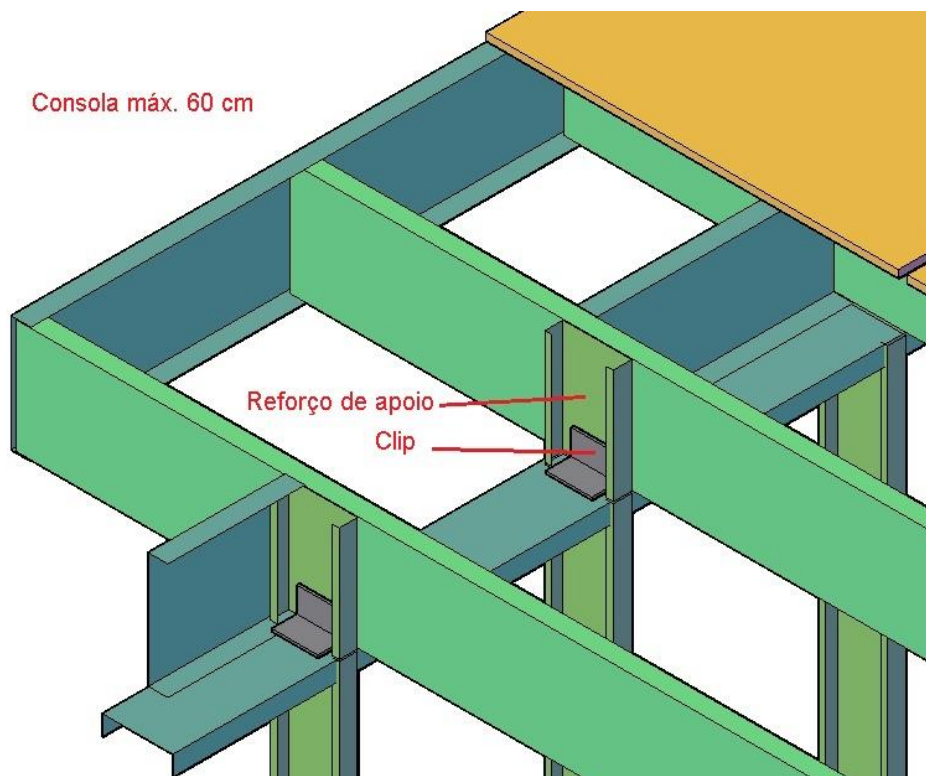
Fixação de pavimento em consola sobre barrote
